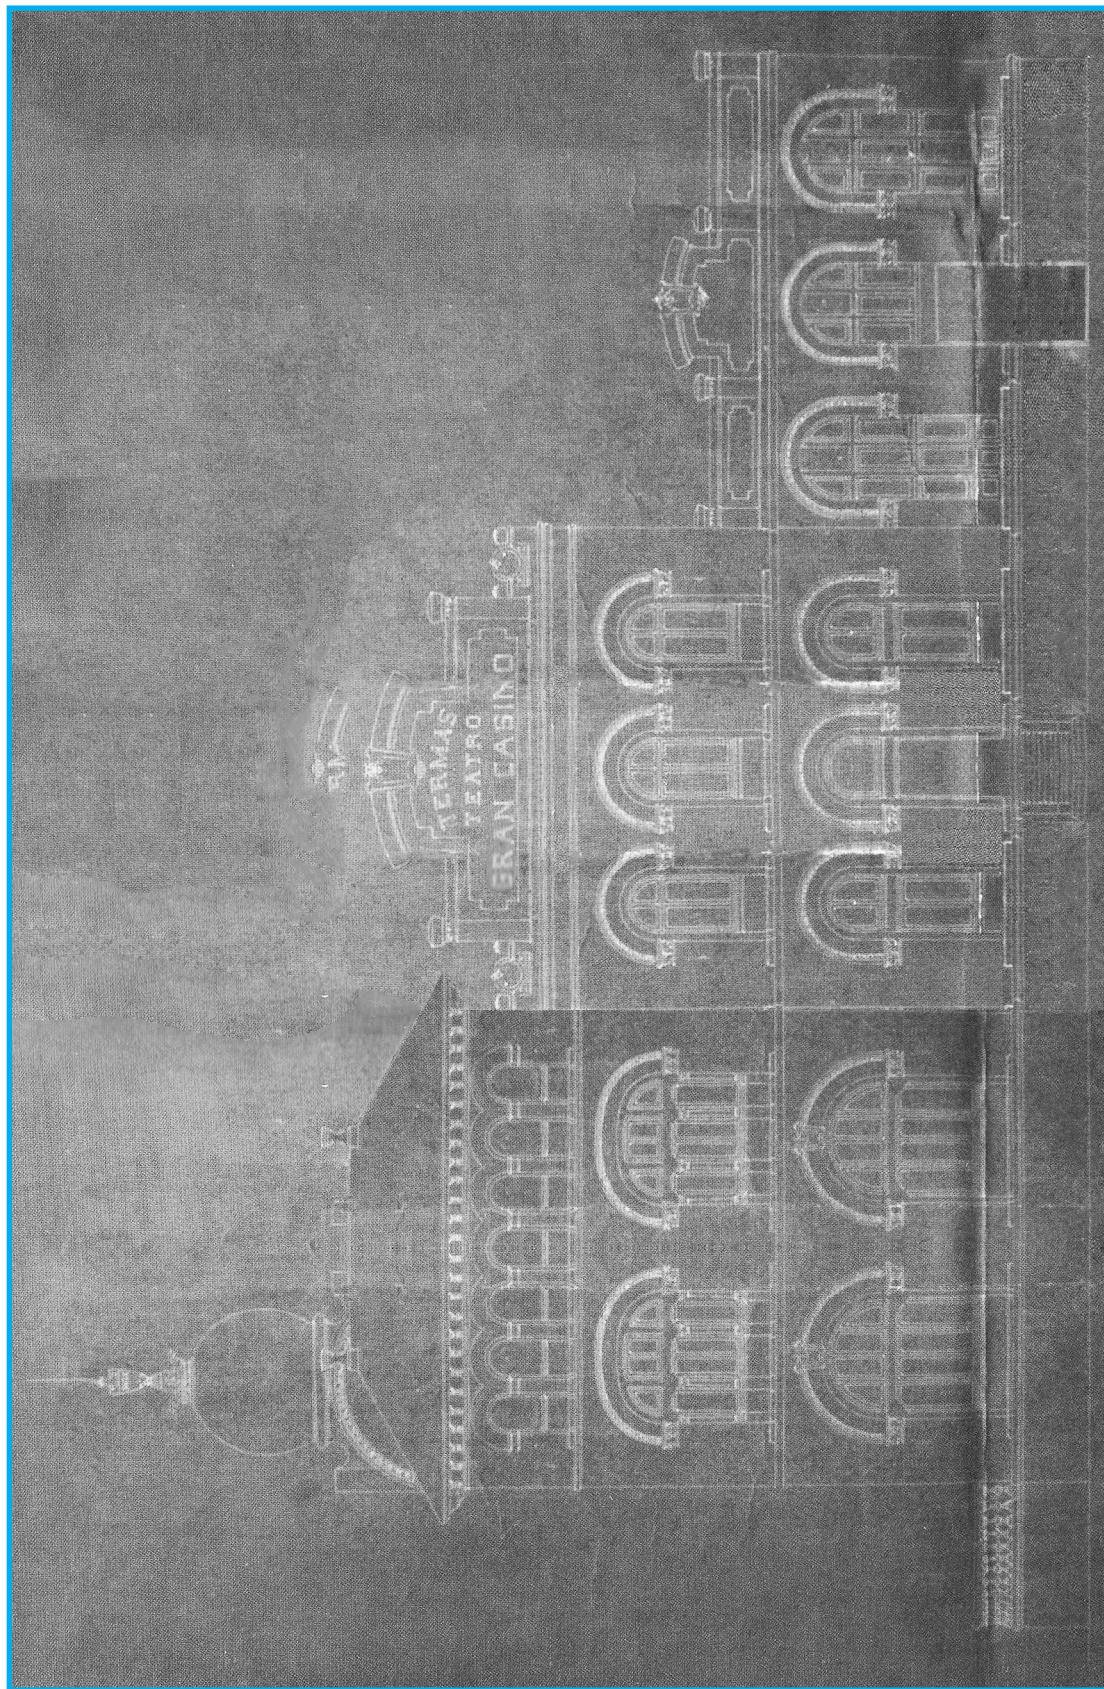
Calco de la fachada al lago del proyecto de Aisa. Col. privada.
